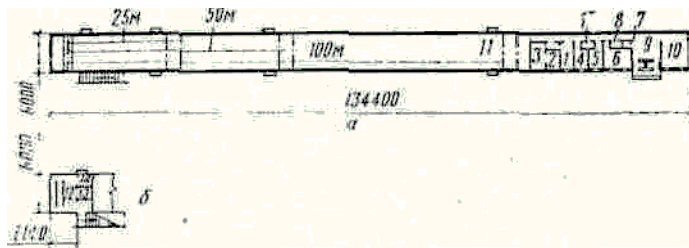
Рис. II. План закрытого тира по типовому проекту № 294-6-2
